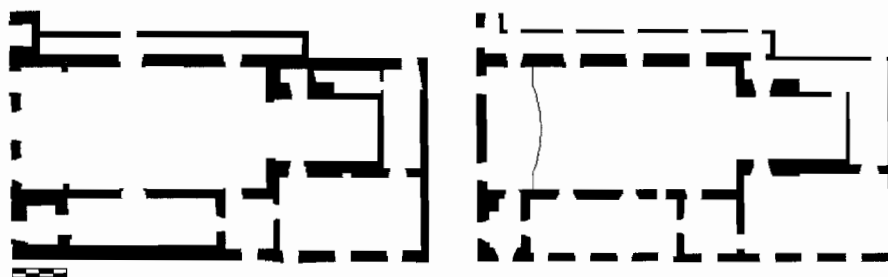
Plantas do térreo e do primeiro pavimento da igreja de Nossa Senhora do Amparo, Olinda-PE, nas quais se nota a diminuição da espessura das alvenarias.
